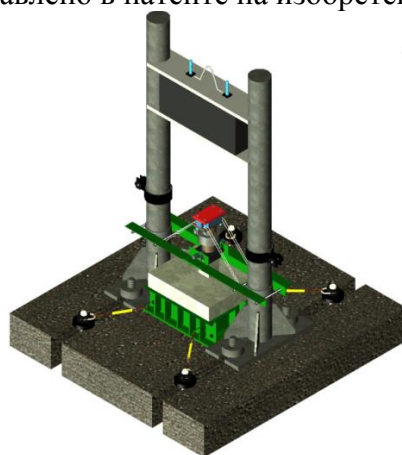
Стенд для испытания железобетонных элементов на продавливание при кратковременном динамическом нагружении
